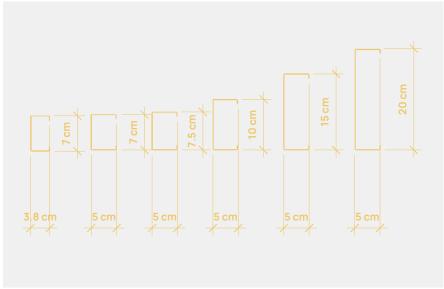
Diagrama de medidas del perfil C o purling. Fuente: Elaboración propia
